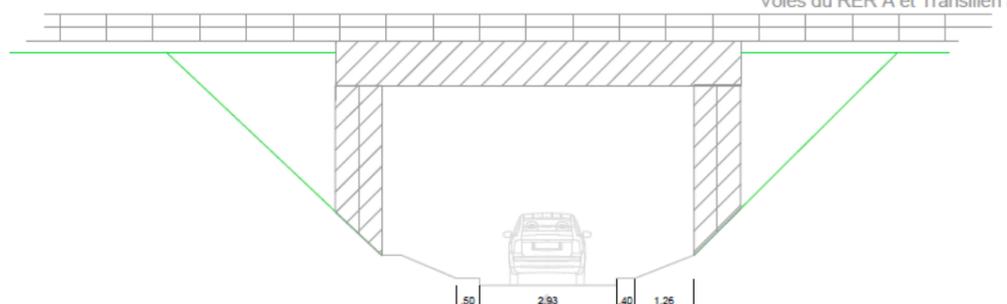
Coupe type du pont-rail d'Achères Ville existant
